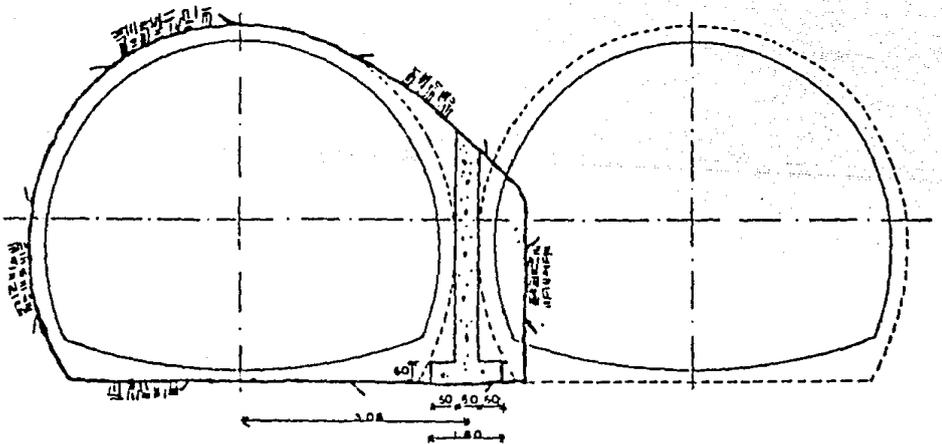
CONSTRUCCION DEL MURO CENTRAL
